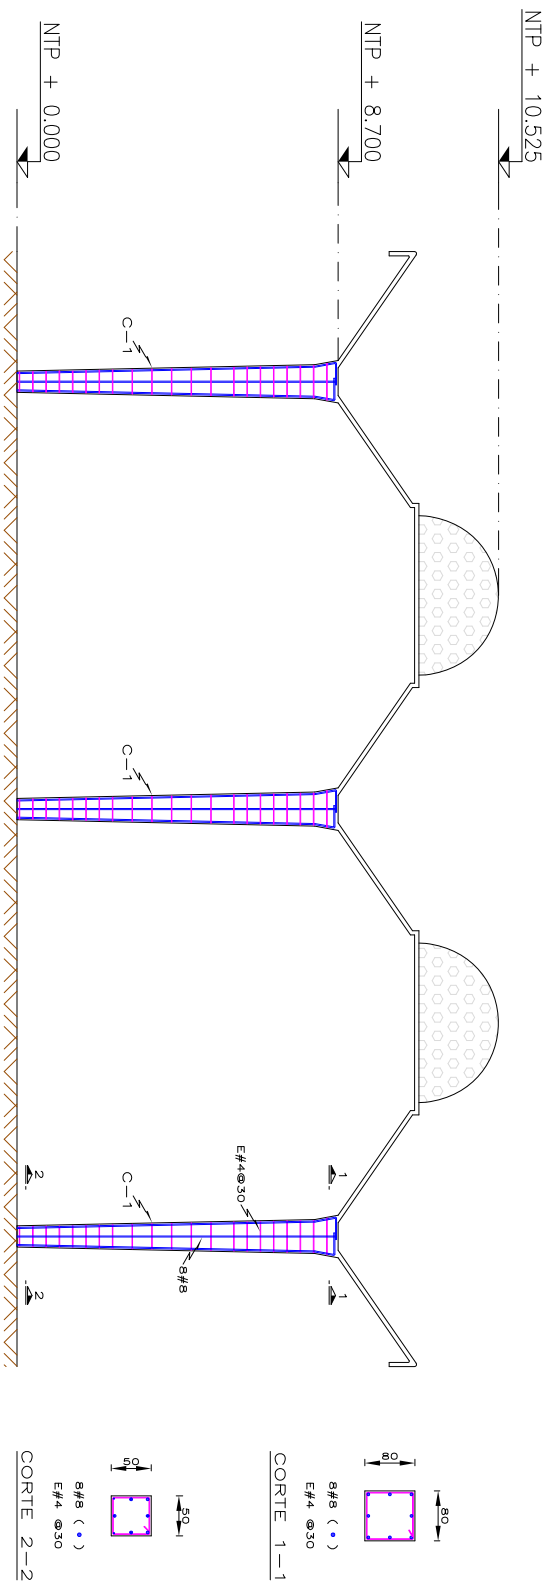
ACERO DE REFUERZO EN COLUMNAS
